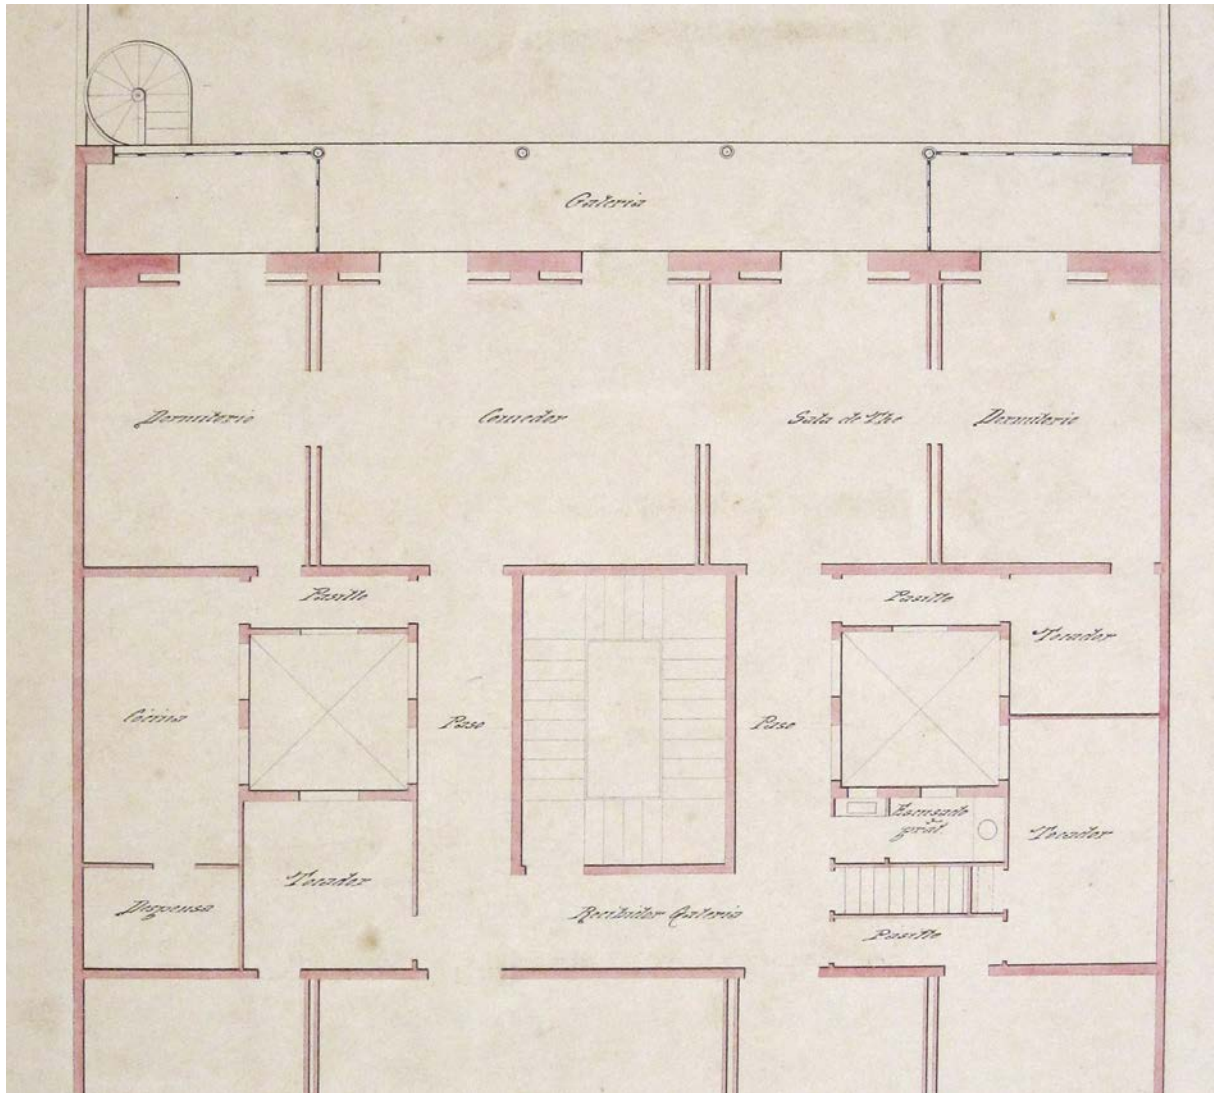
Detall de plànol de planta del pis principal i seccion (casa José Añés, arquitectes Bassegoda, 1881-1883).
